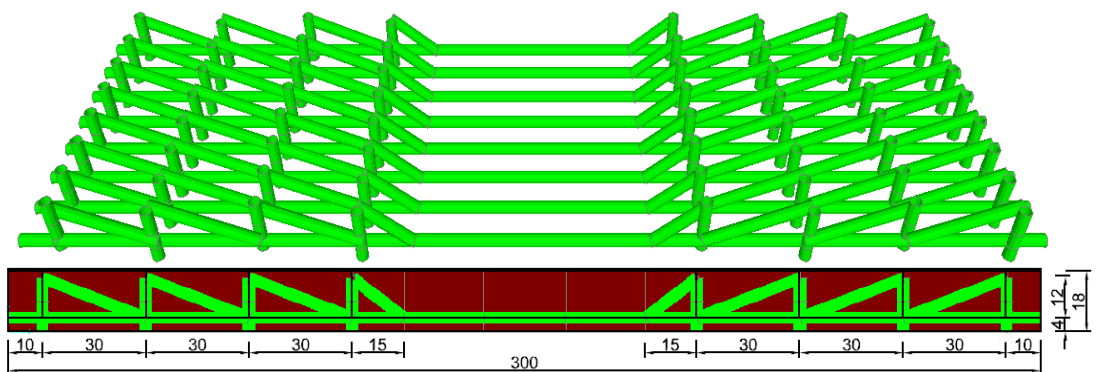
Disposição construtiva de armadura longitudinal da laje L3.
